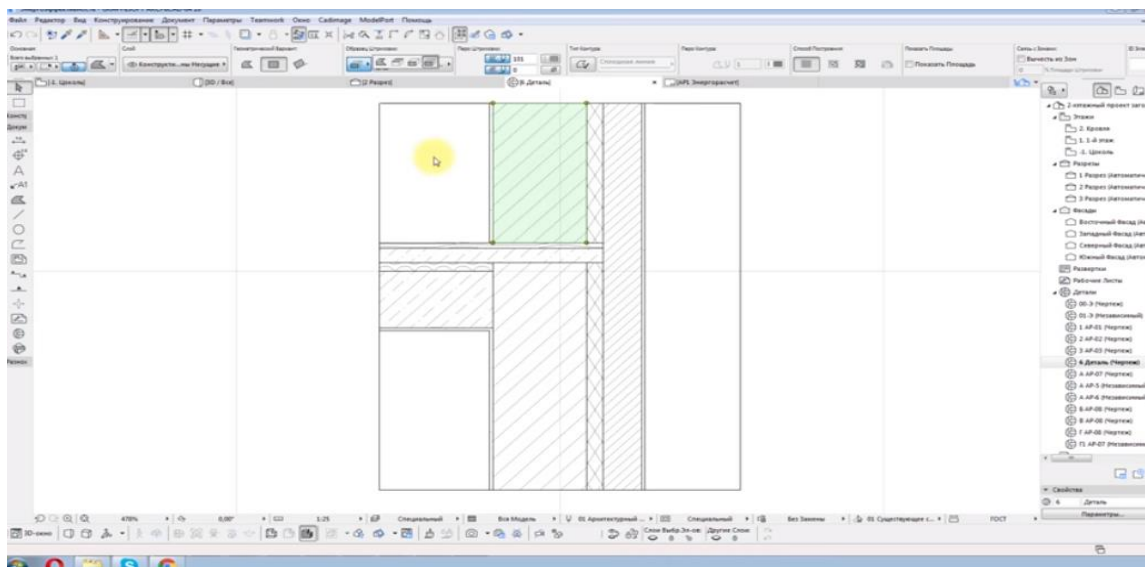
Вузол обпирання плити перекриття на цегляну стіну.
